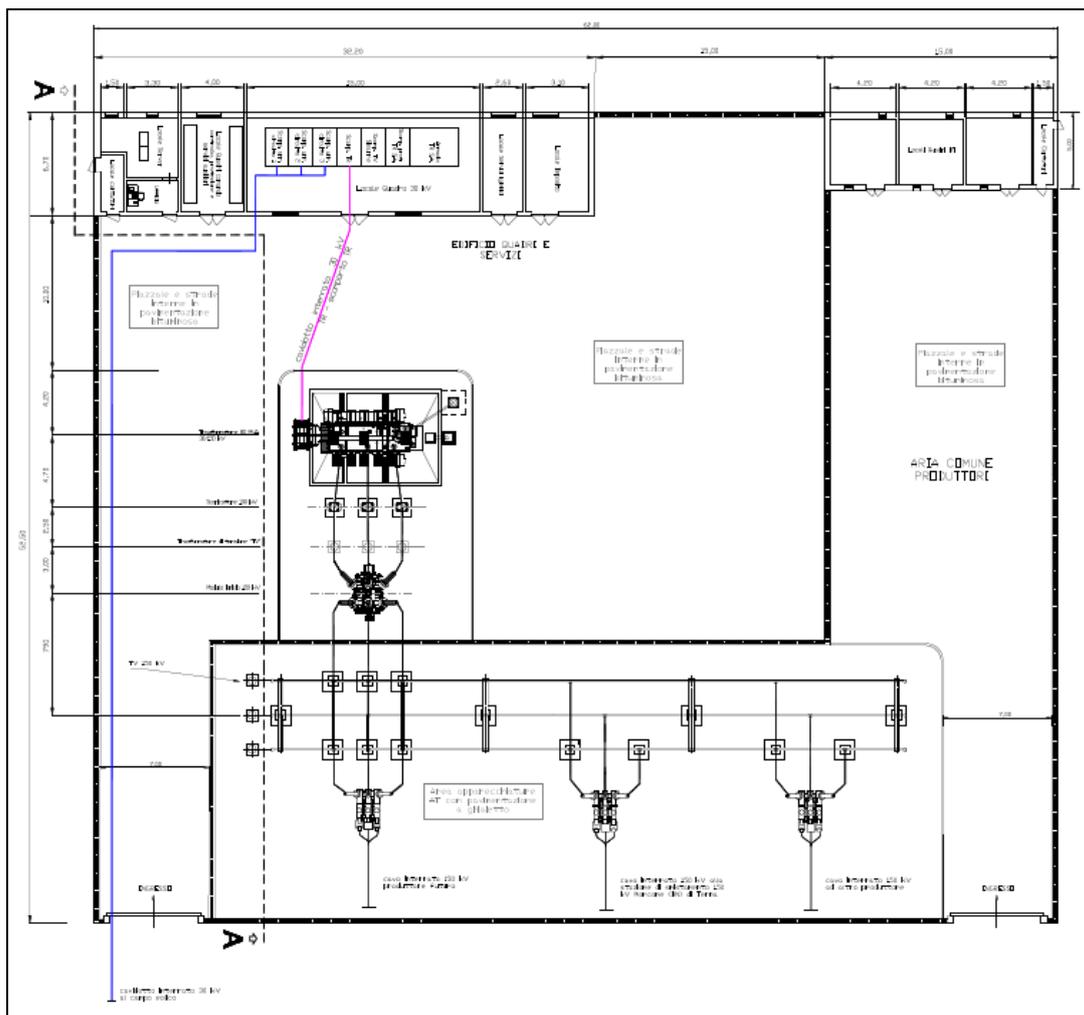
Planimetria stazione di trasformazione 30/150 kV COGEIN.
